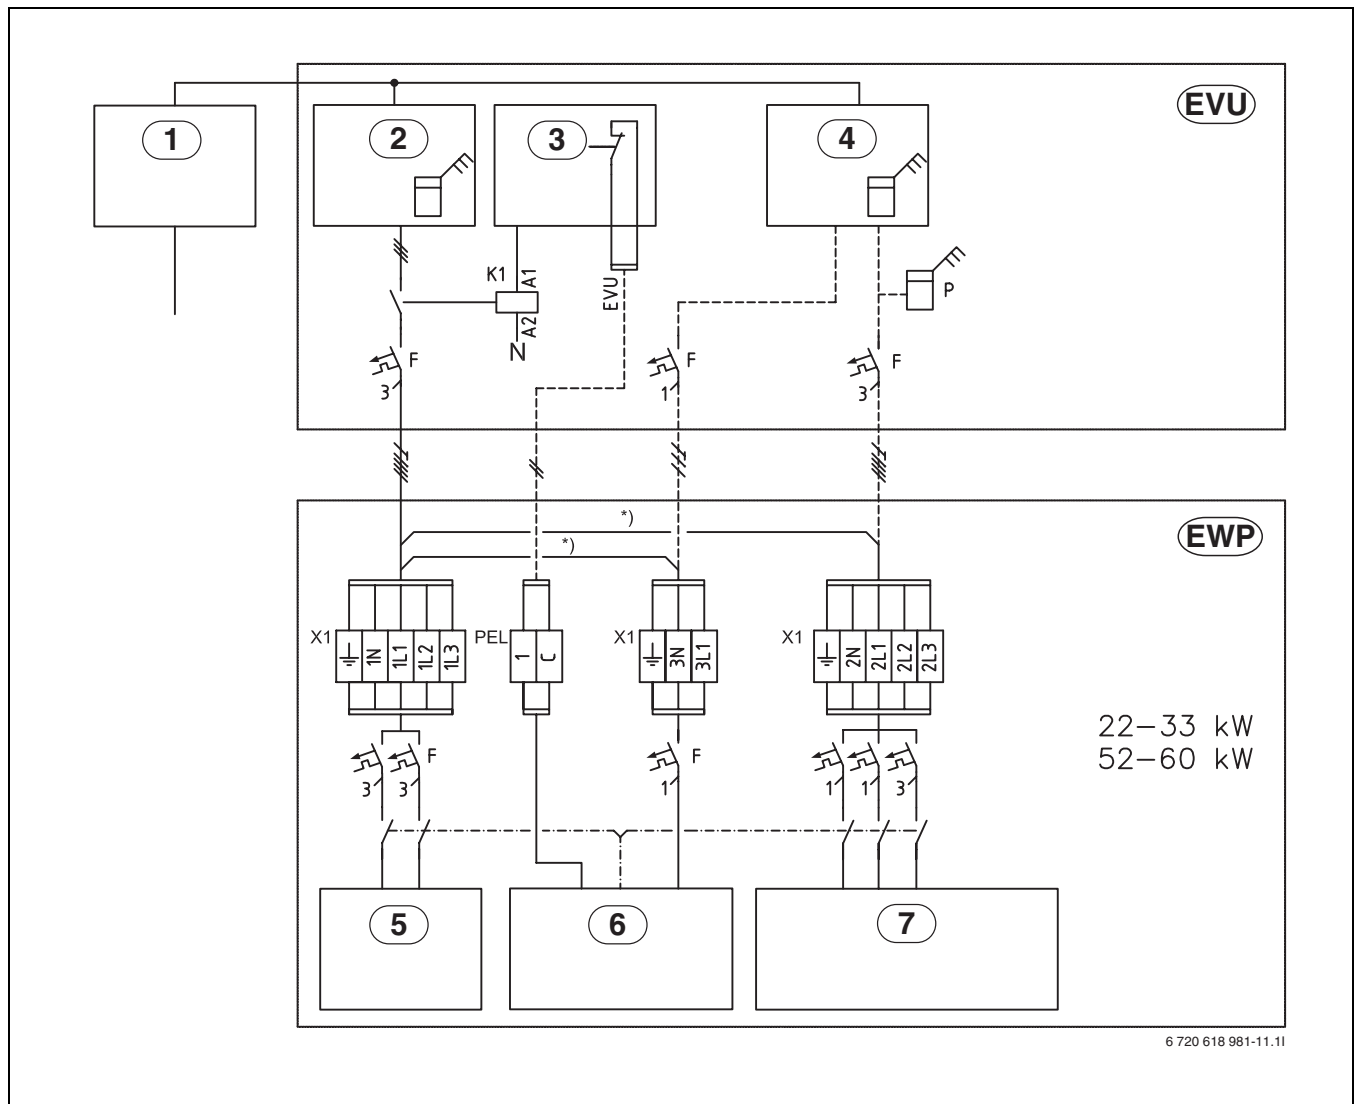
Übersicht Anschluss Elektroschaltschrank - Wärmepumpe (T 220-1 - T 330-1, T 520-1 - T 600-1)
